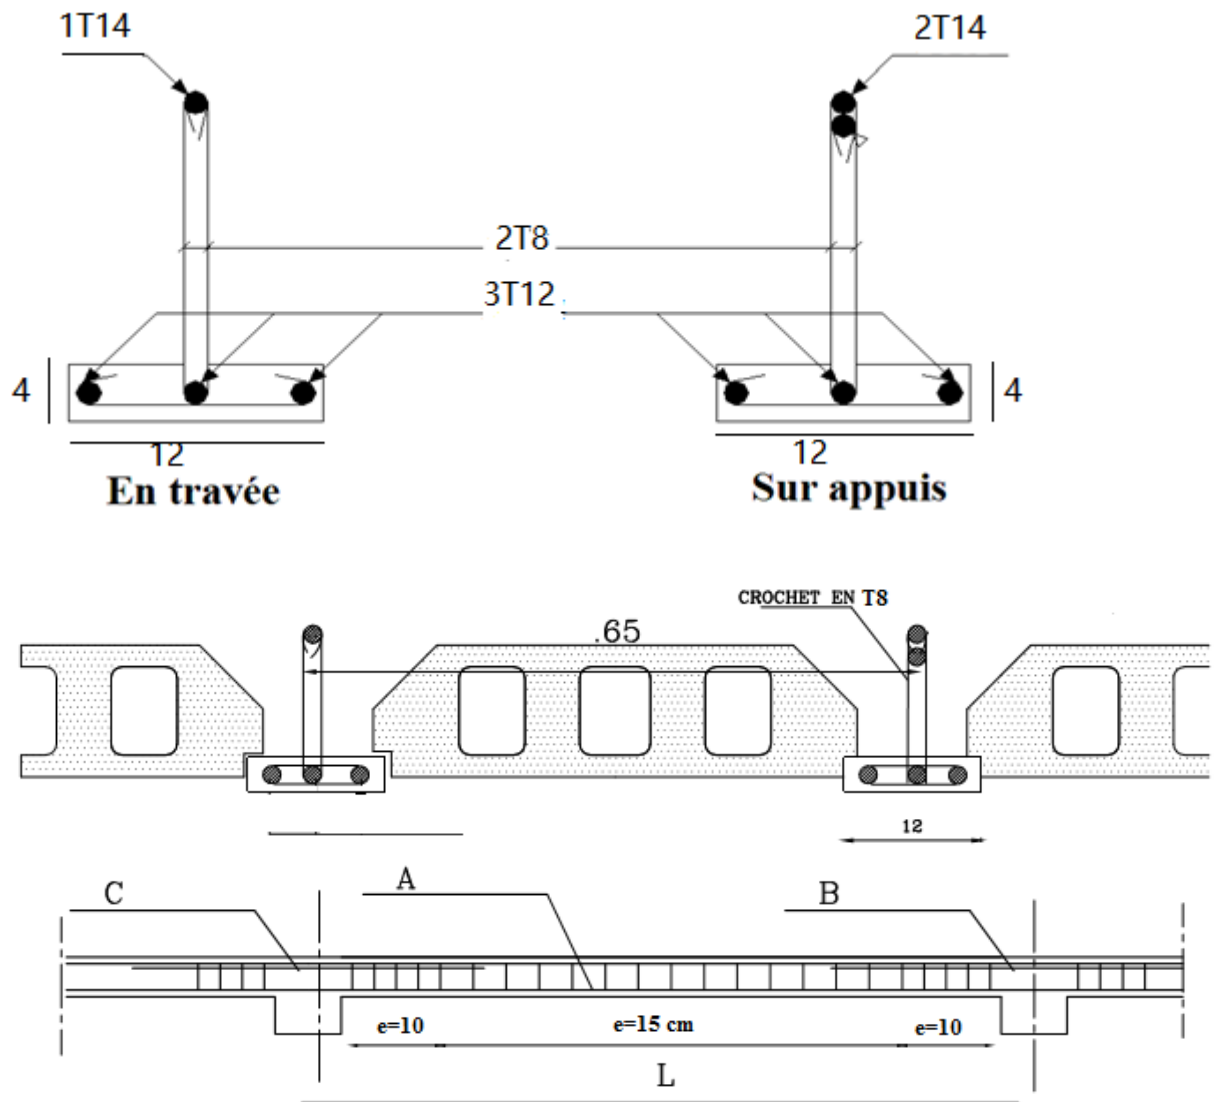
Ferrailage des poutrelles en travée et en appuis.
